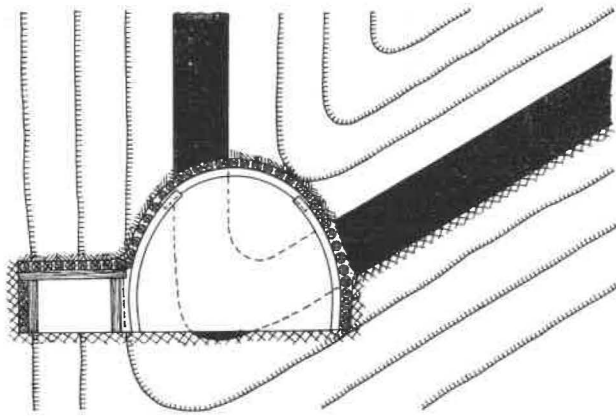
Voie de base en crochon de pied : soutènement provisoire en cadres Toussaint-Heintzmann.
